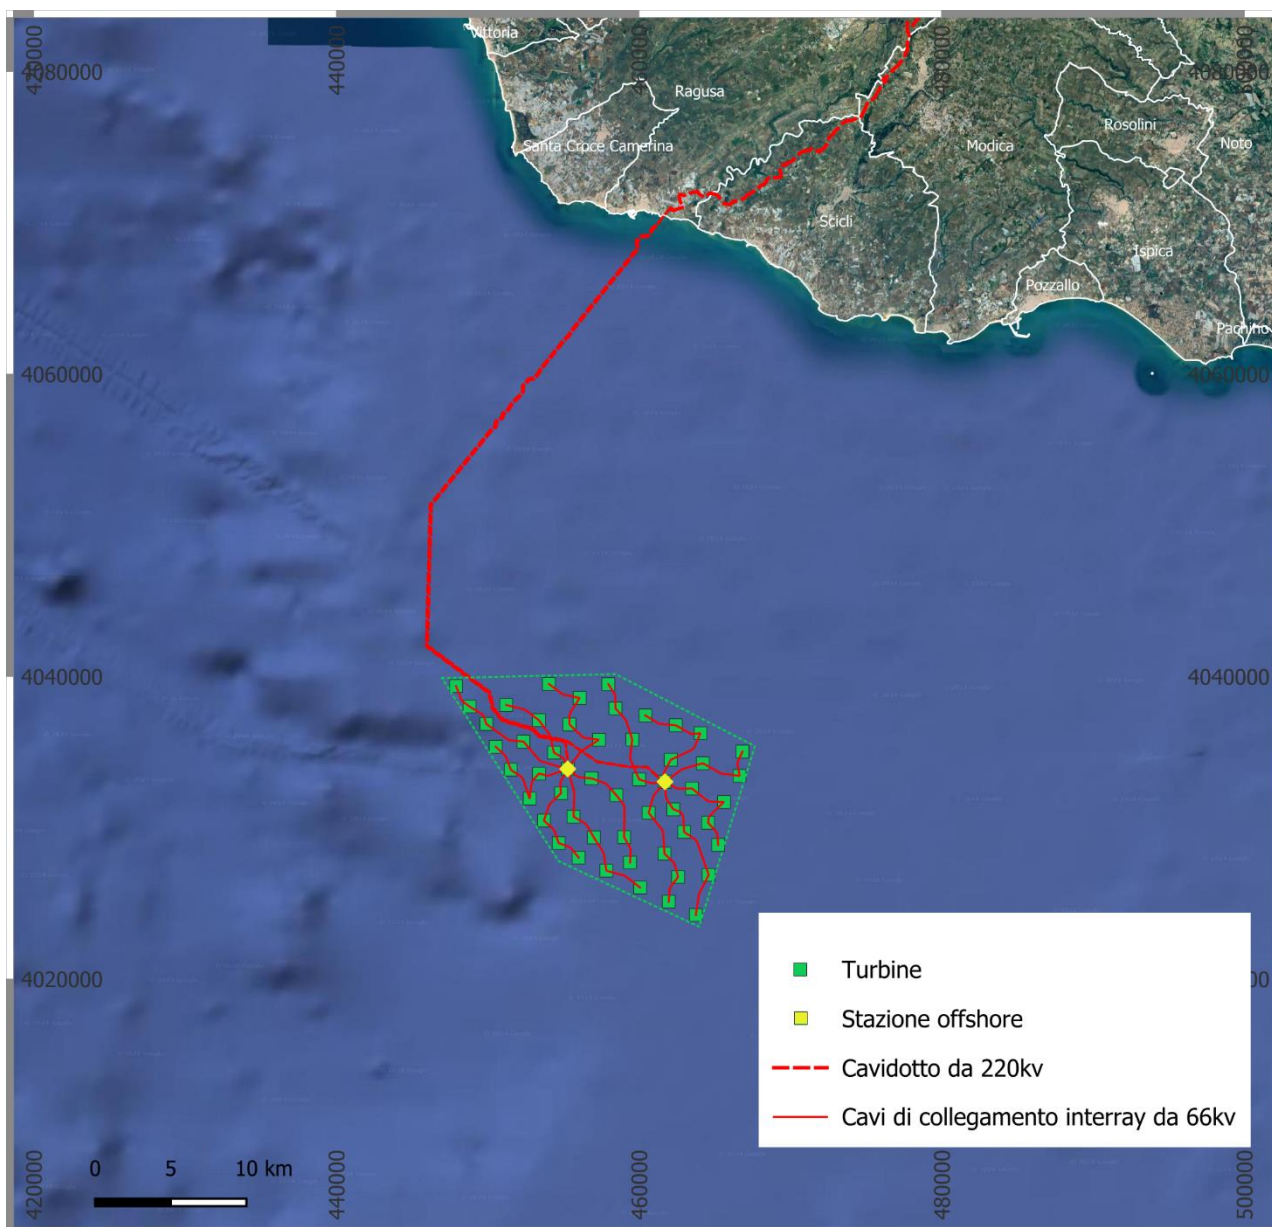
Planimetria generale del tracciato elettrodotto in cavo marino 220kV
